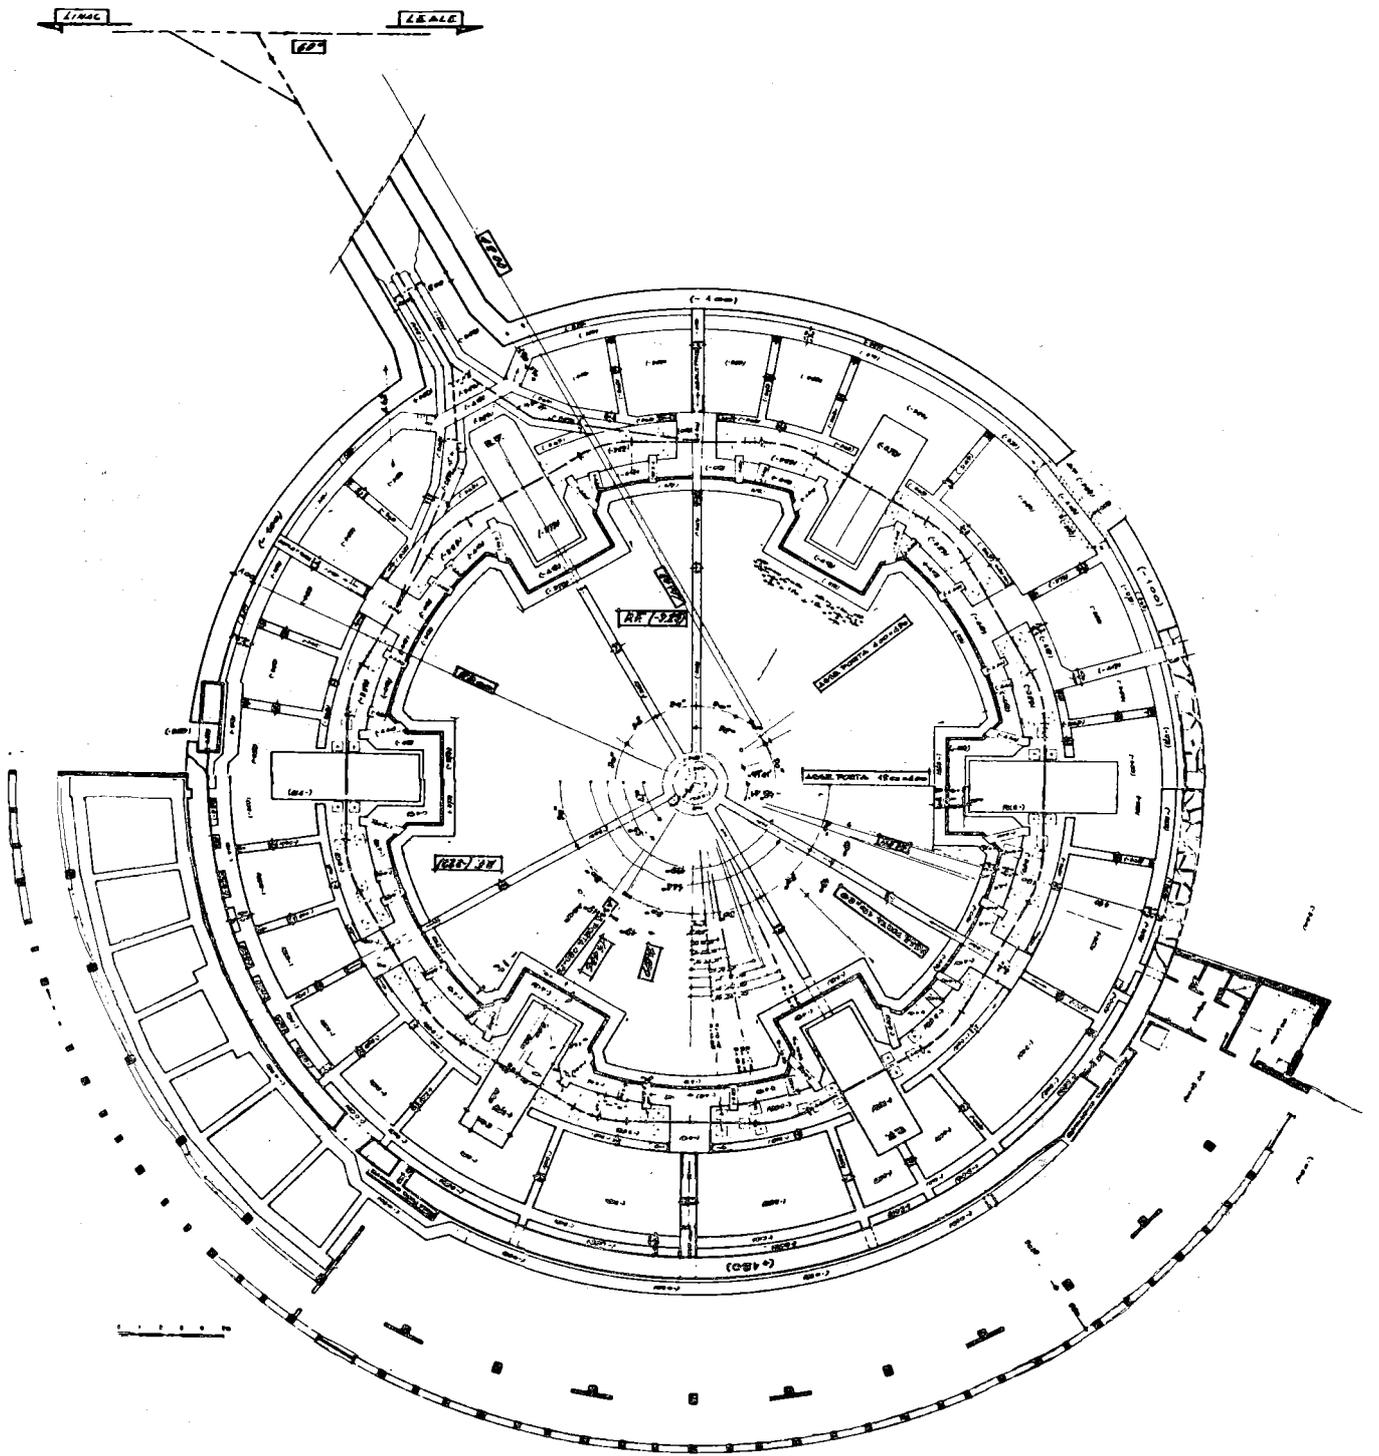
Sala anello d'accumulazione. Pianta del pavimento con canalette e fosse sperimentali.
